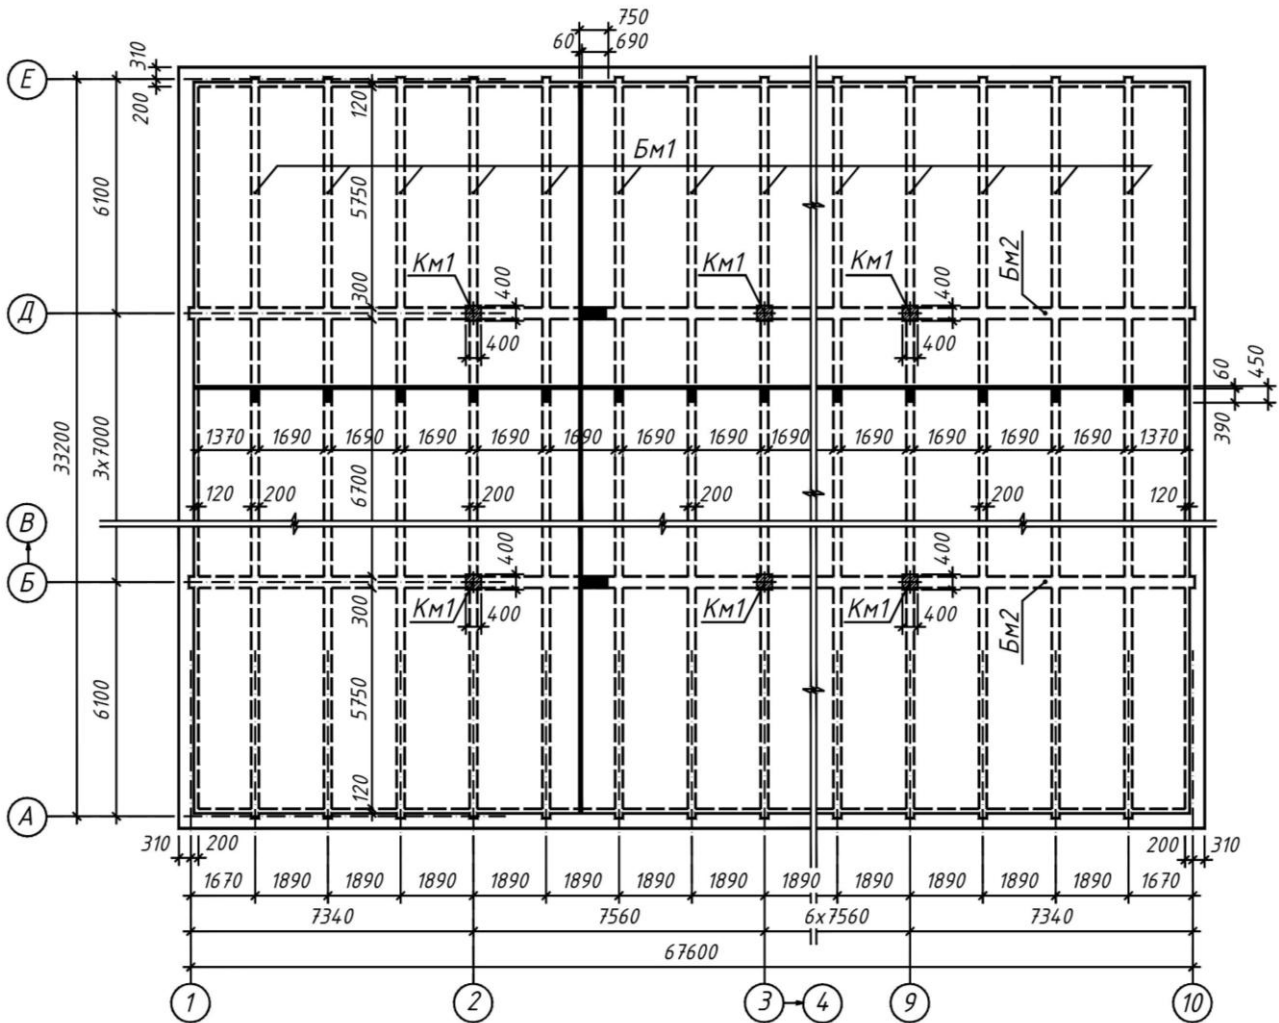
План перекриття над підземним паркінгом торгівельно-розважального центру
